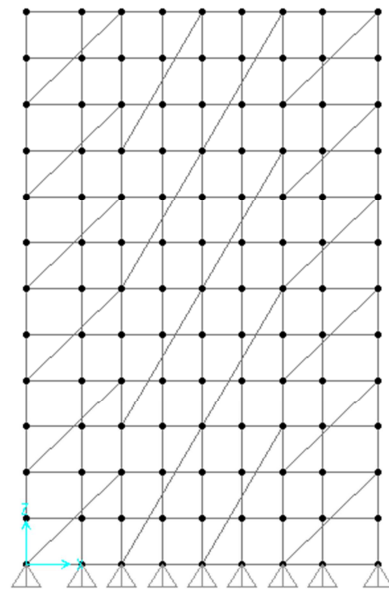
Configuração dos Planos de Contraventamento Vertical Com Elementos de Contraventamento Grandes
